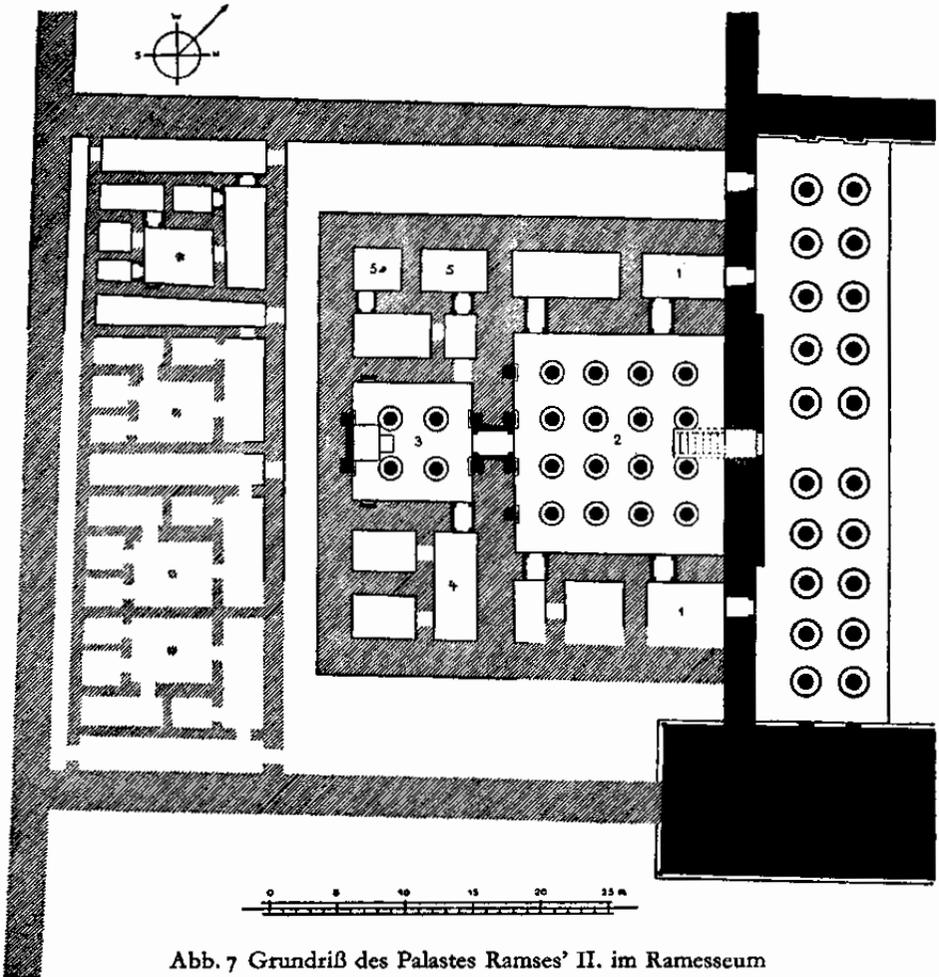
Grundriß des Palastes Ramses' II. im Ramesseum
